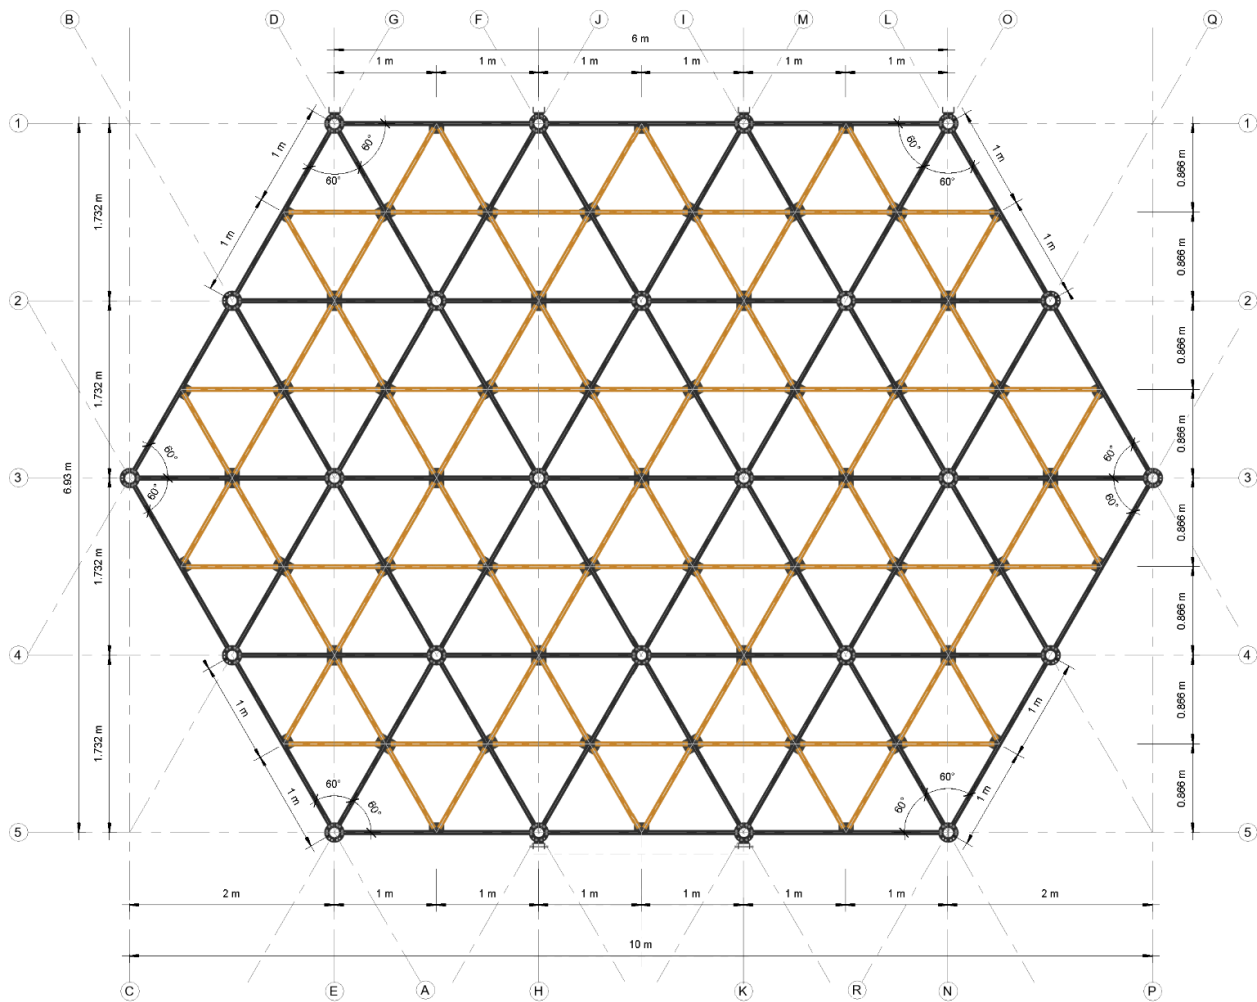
Planta de estructura modular de piso para la tipología B.<sup>335</sup>
